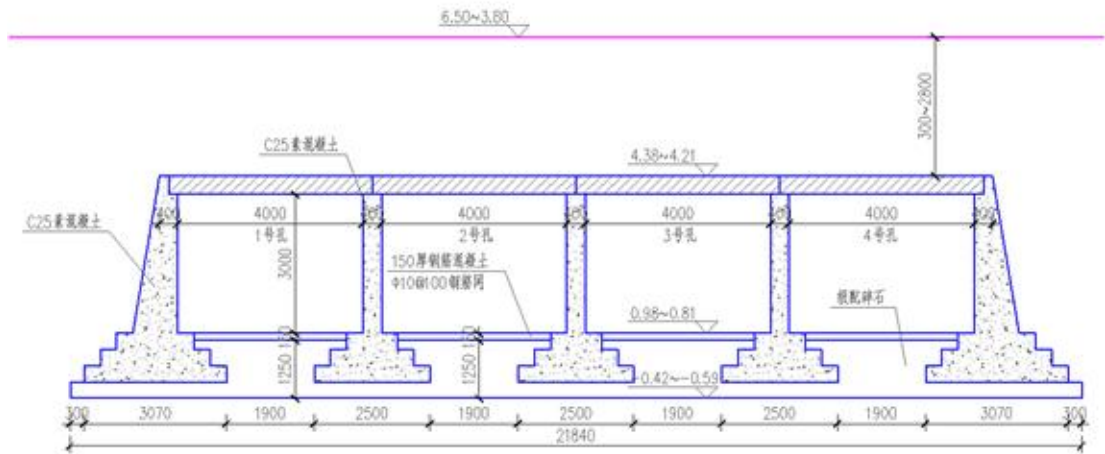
非桥梁桩基段的四孔涵施工图断面
